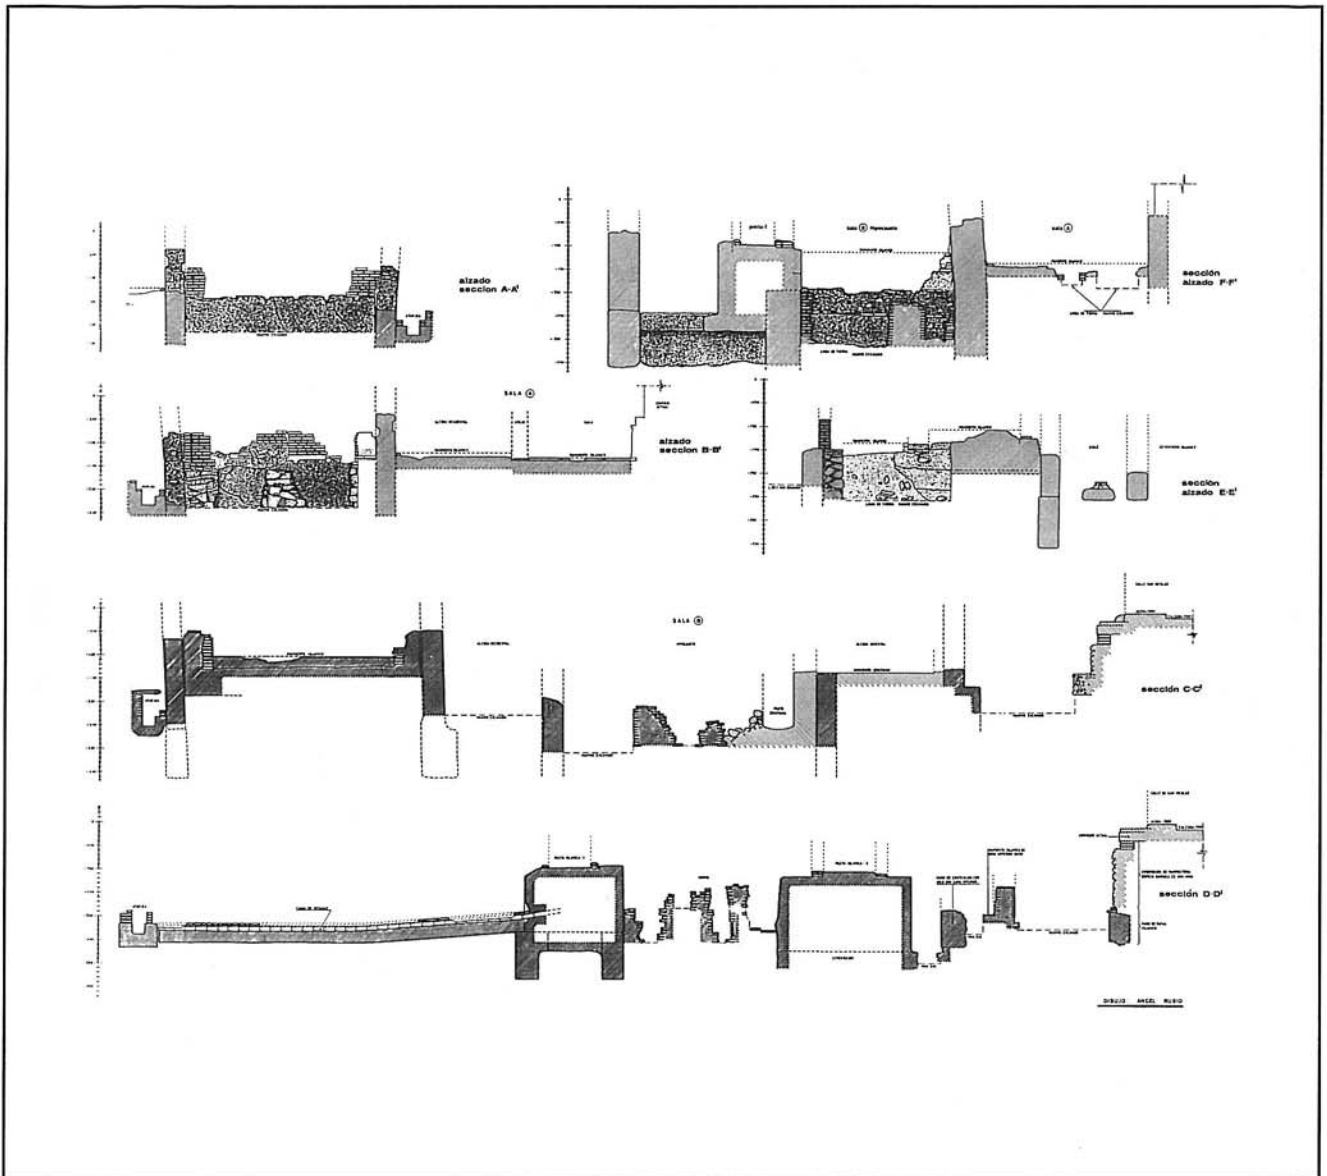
Baño de San Nicolás. Alzados y secciones.
